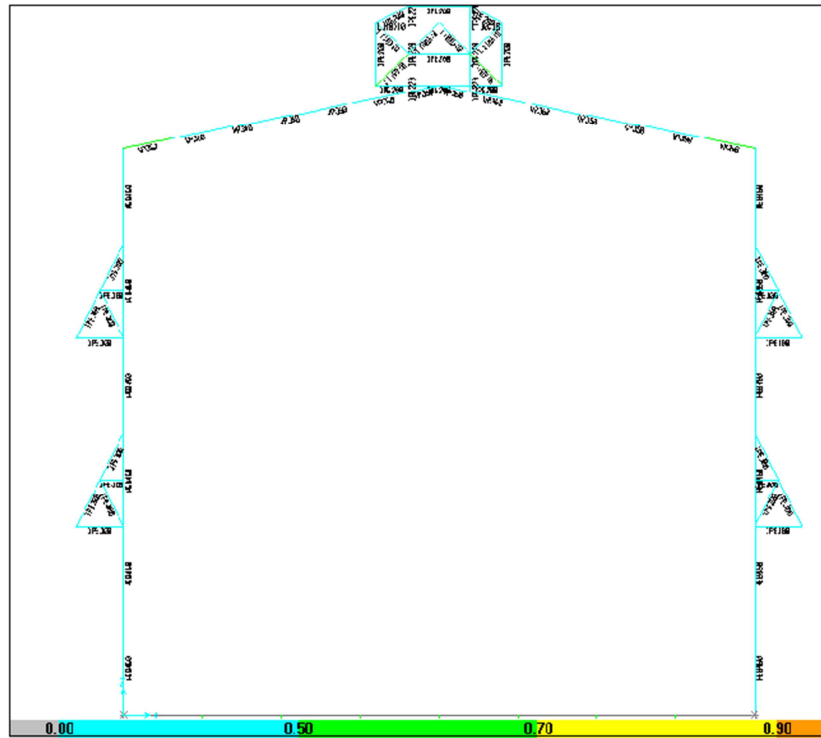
Vigas principales y vigas secundarias, vista lateral
